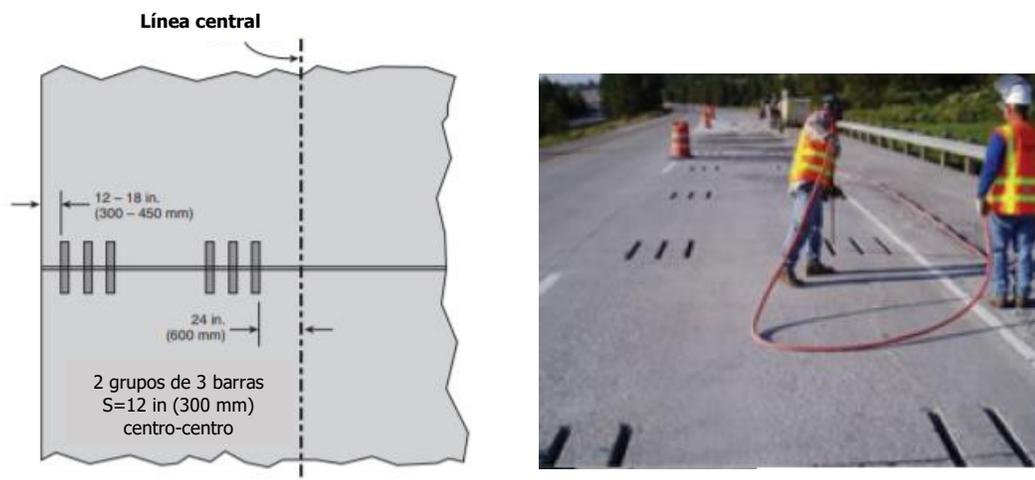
Configuración típica de reemplazo de dovelas en juntas longitudinales
